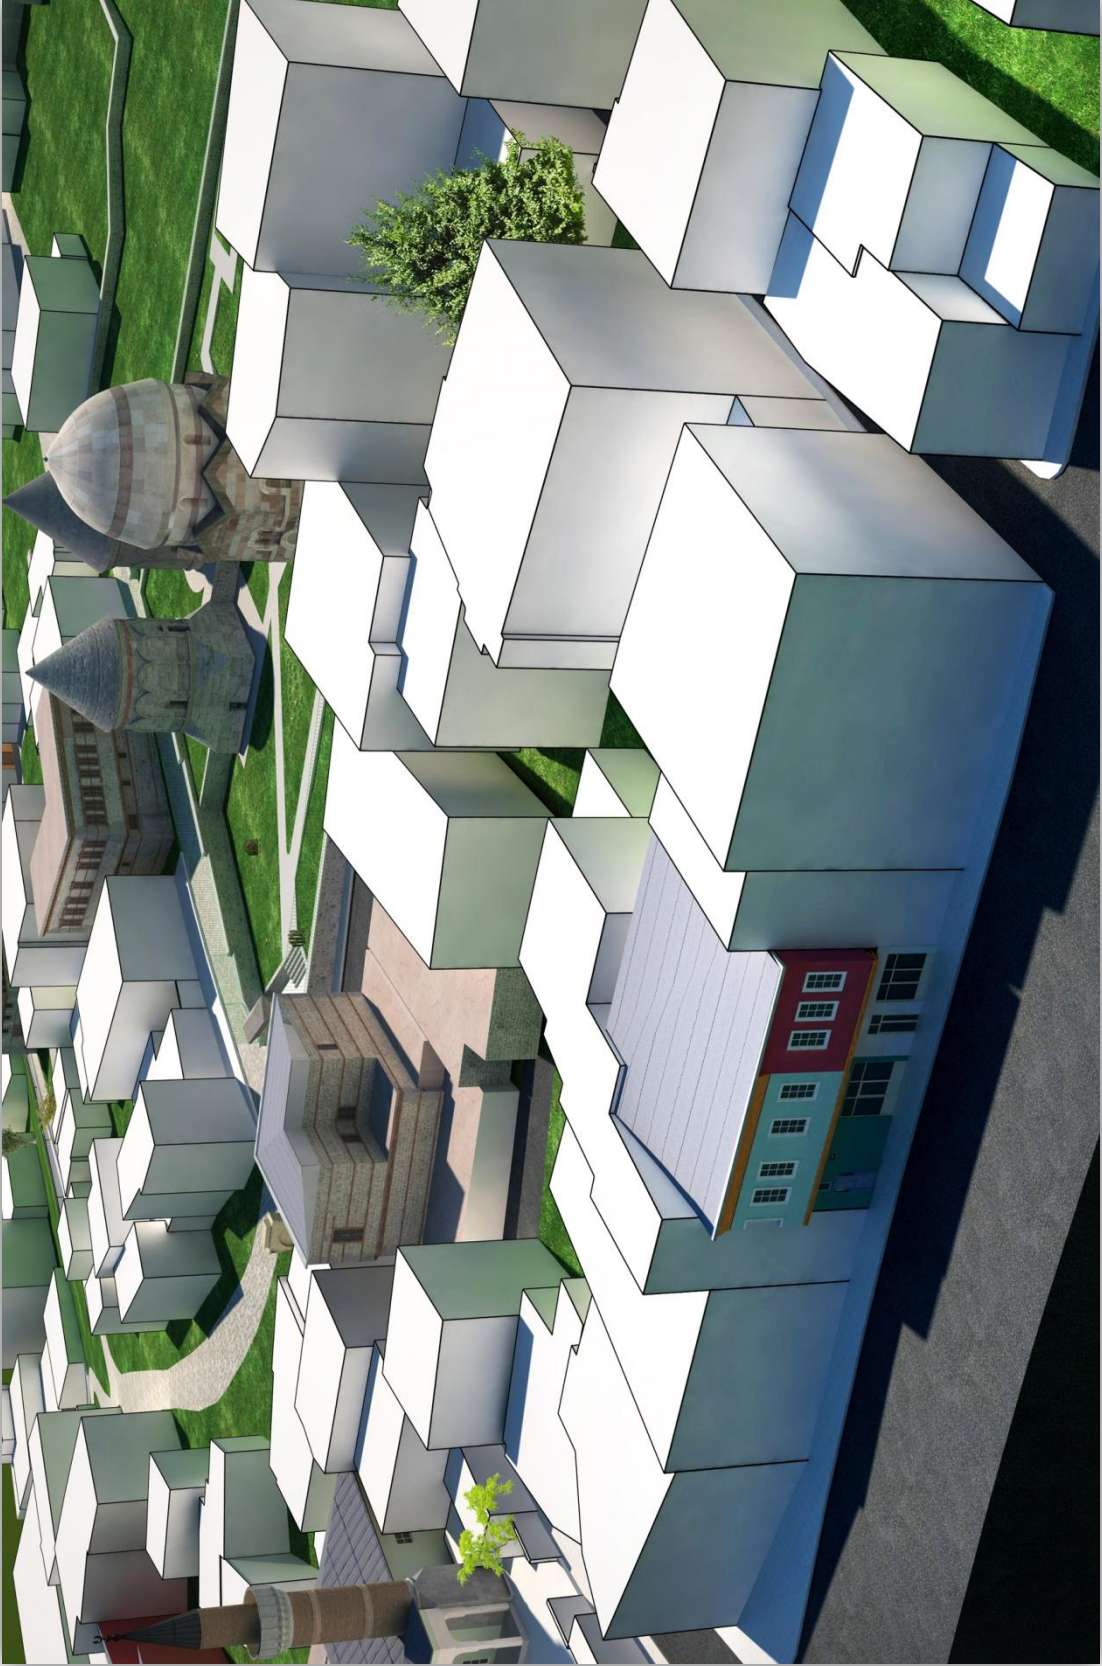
Ankette sunulan 4 nolu örneğin vaziyet planı
